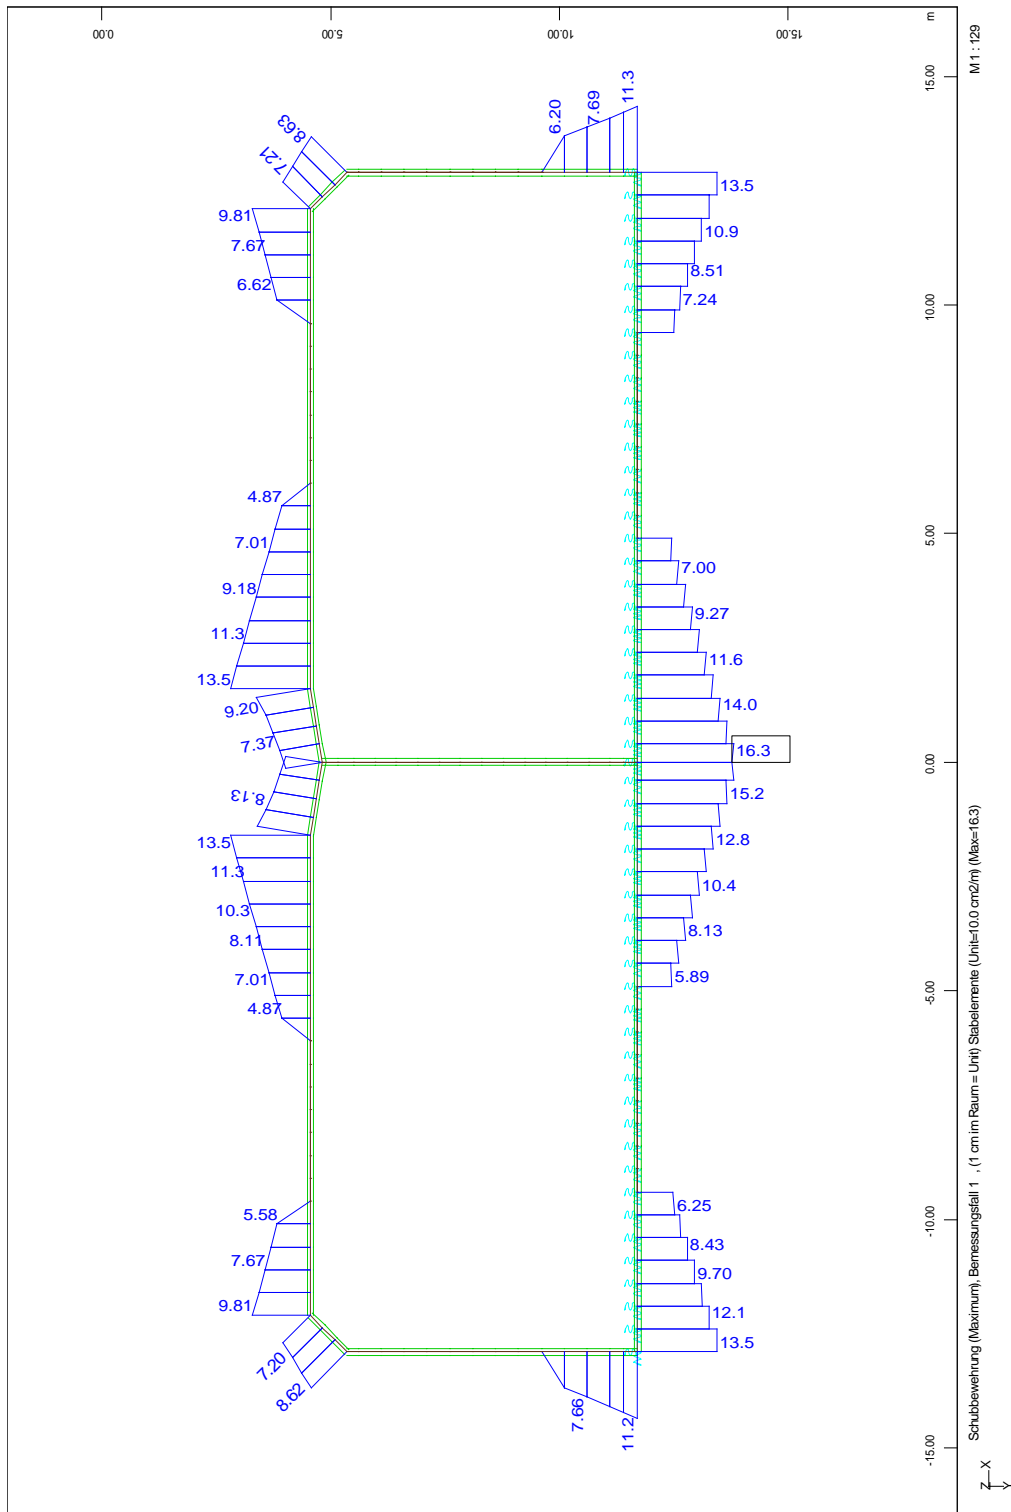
Schubbewehrung, ständige und vorübergehende Bemessungssituation
